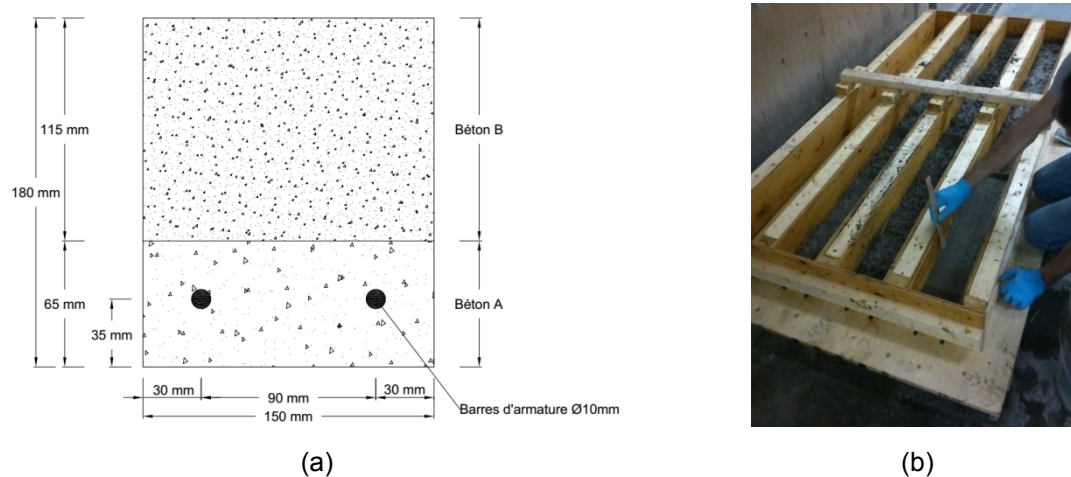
(a) Coupe transversale typique d'une poutre - (b) coffrage et coulage du béton des poutres
